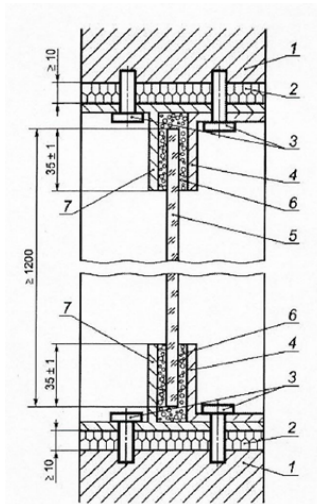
Схема крепления образца: 1 – печь; 2 – плита из минерального волокна; 3 – крепления; 4, 7 – стальная испытательная рама; 5 – испытуемый образец; 6 – асбестовая прокладка
